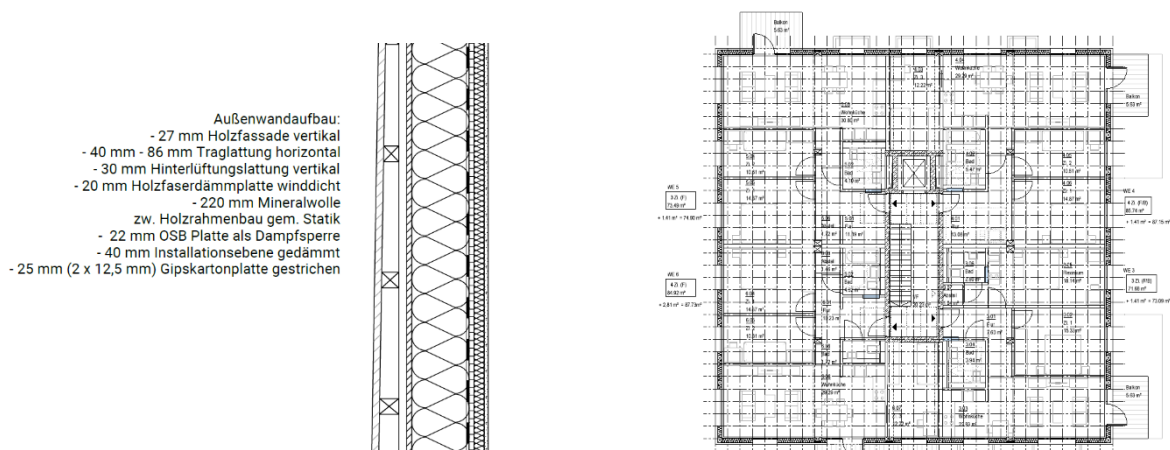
Außenwandaufbau (links) Grundriss 1.OG Achsenraster (rechts)
